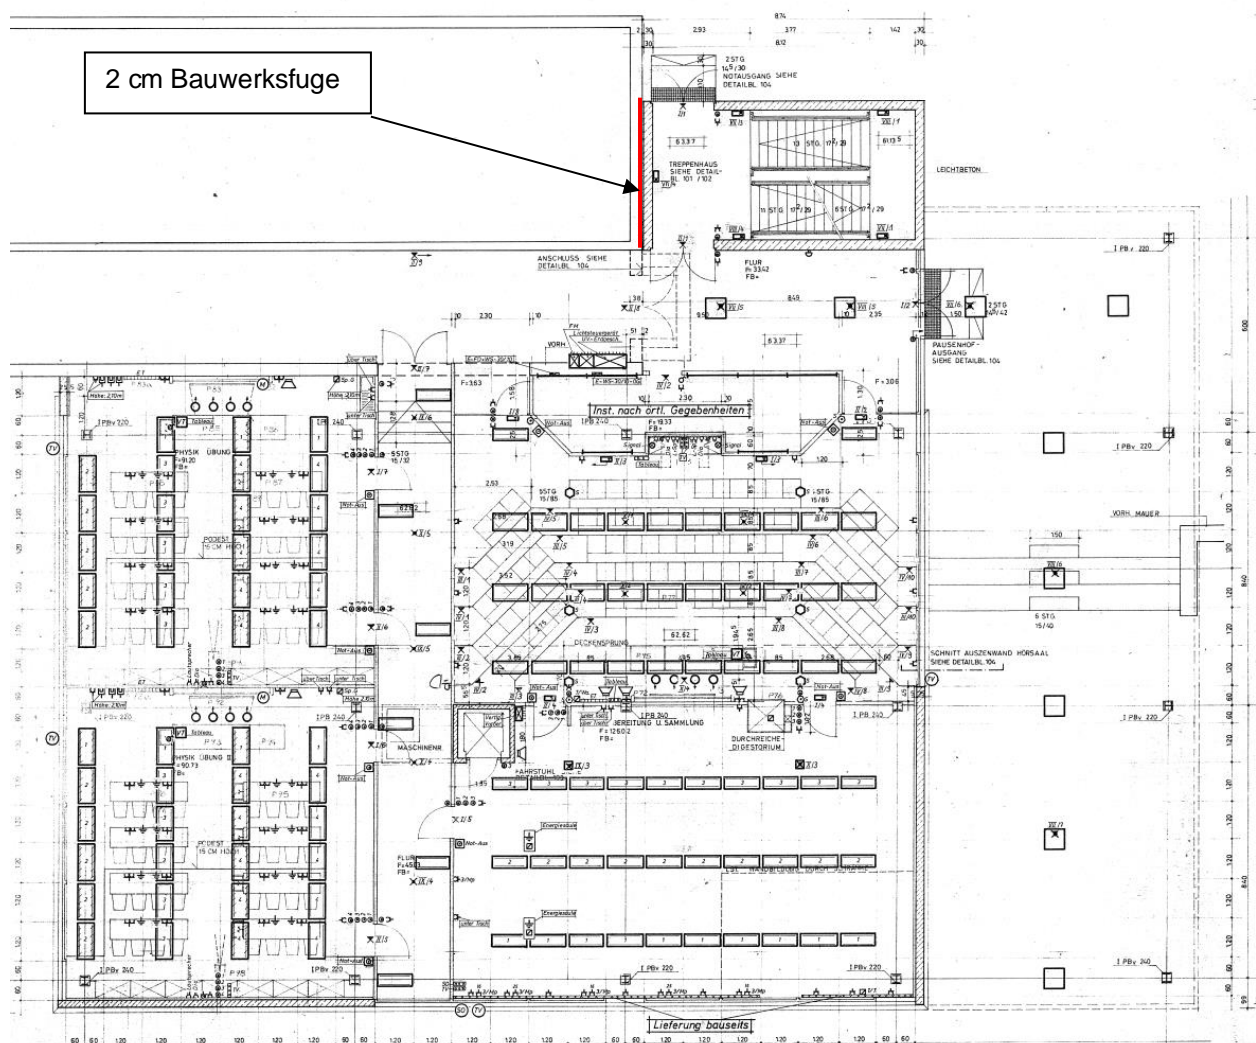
Grundriss Trakt N – Bestandsplan
